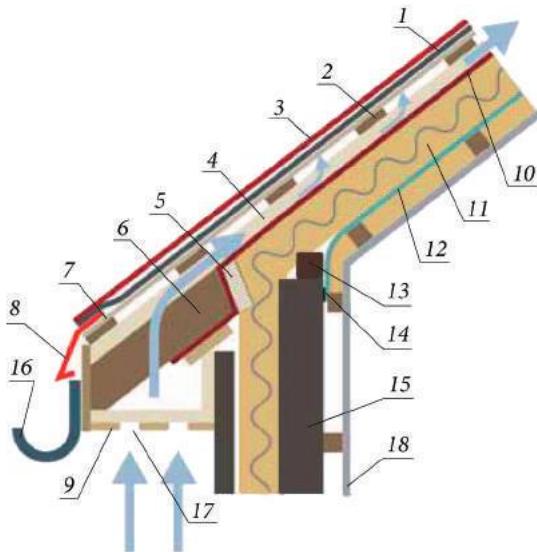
Принципиальная схема устройства притока наружного воздуха через карниз: 1 — подкладочный ковер; 2 — разреженная обрешетка; 3 — гибкая черепица; 4 — контробрешетка; 5 — лобовая доска; 6 — стропильная нога; 7 — разреженная обрешетка; 8 — карнизная планка; 9 — софитная планка; 10 — ветрозащита; 11 — утеплитель; 12 — пароизоляция; 13 — мауэрлат; 14 — гидроизоляция (бутилкаучуковая лента); 15 — наружная стена; 16 — крюк водостока; 17 — отверстия для притока воздуха; 18 — два слоя гипсокартона
